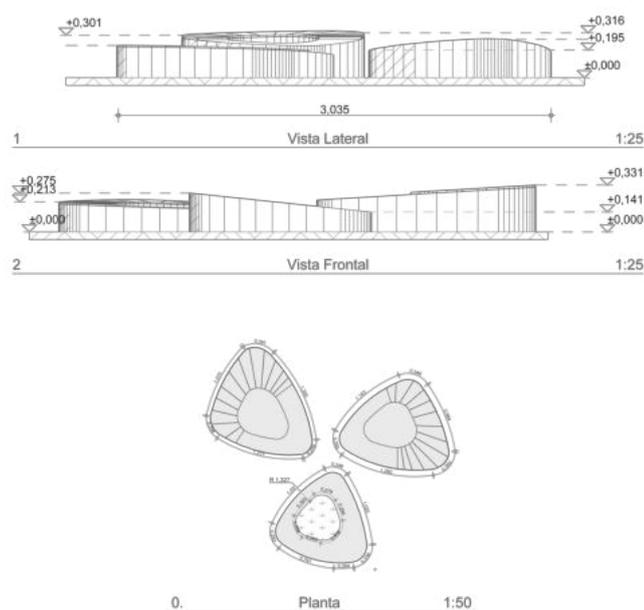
Planos 7 – Vista frontal y planta arquitectónica de Banca 1. Fuente: Elaboración propia Nota: Distribución de planta arquitectónica y elevaciones
